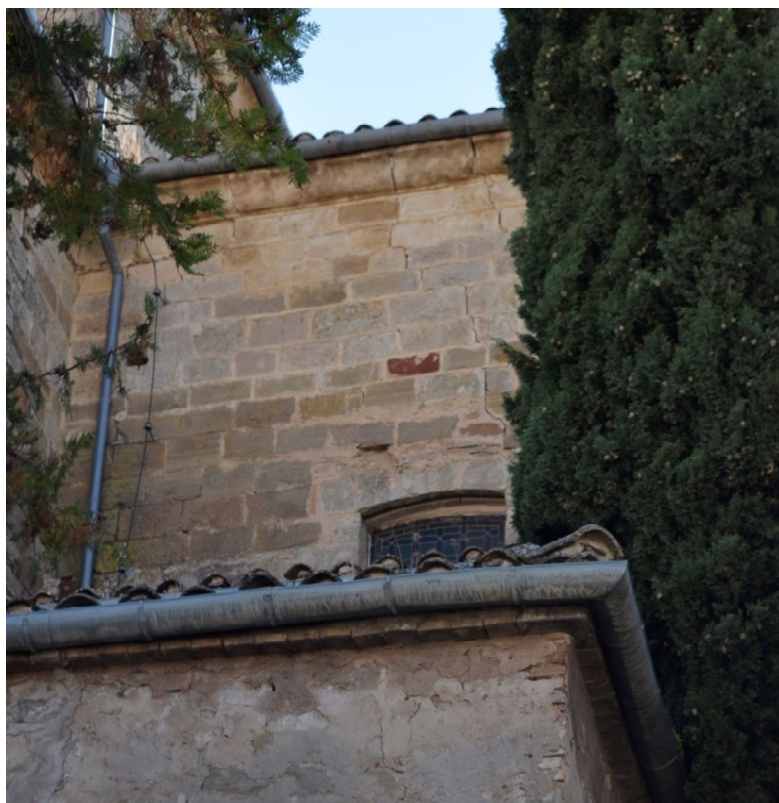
Grieta a 45 grados correspondiente a la ficha número 9.
